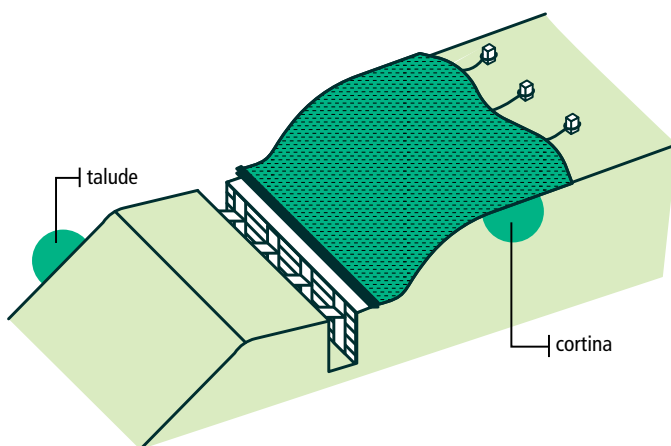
ESCAVAÇÃO MISTA COM PAREDES EM TALUDES E COM PAREDES PROTEGIDAS POR CORTINAS
